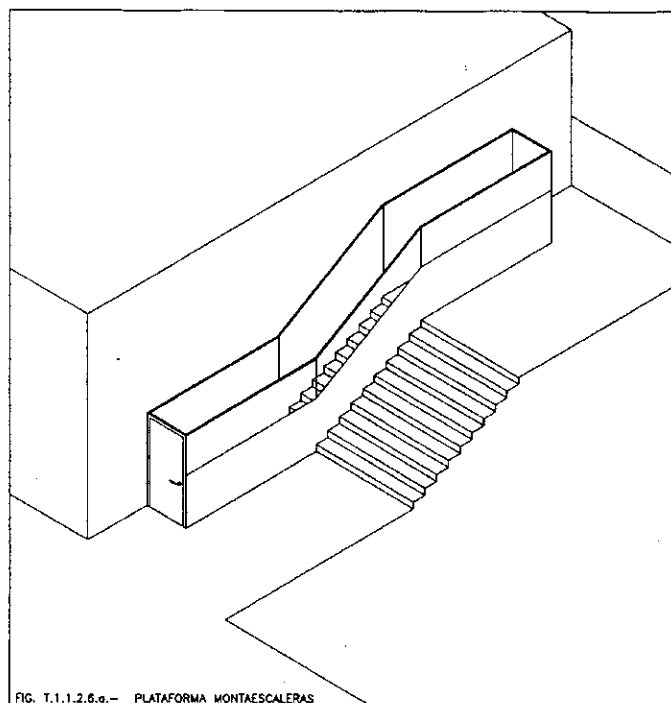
a.- PLATAFORMA MONTAESCALERAS
